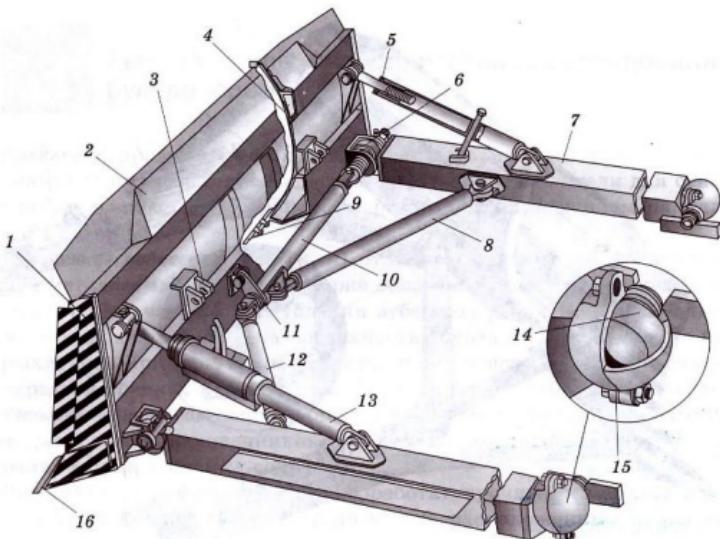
Оборудование бульдозера с неповоротным отвалом с шарнирным креплением:
